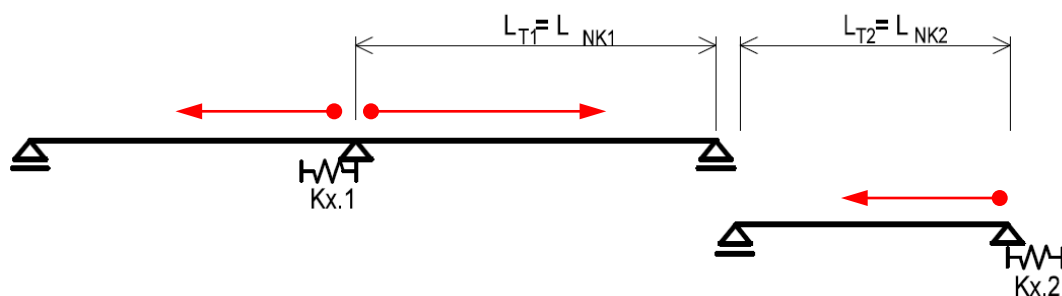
Příklad redukce účinků od teplotní změny NK- zmenšení dilatující délky L_T
